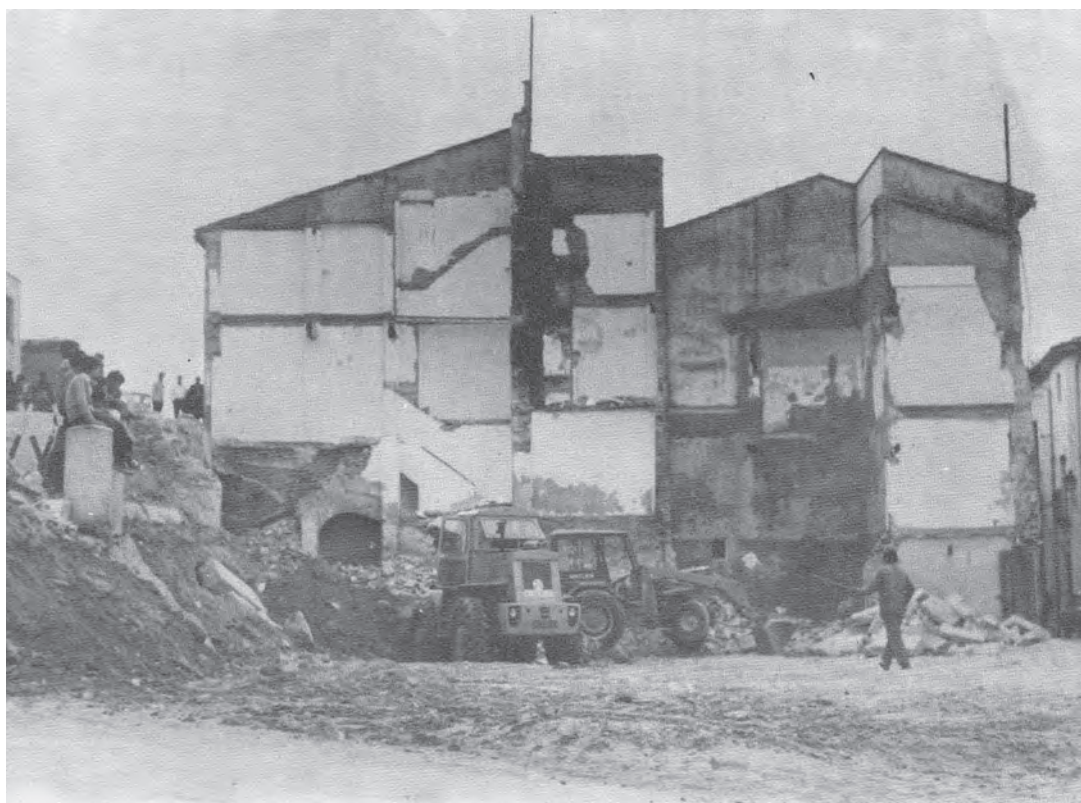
(dalt). Treballs d'enderrocament de la plaça elevada i les edificacions, abril de 1973 (*Programa de Feria y Fiestas de Oliva*, 1973).
